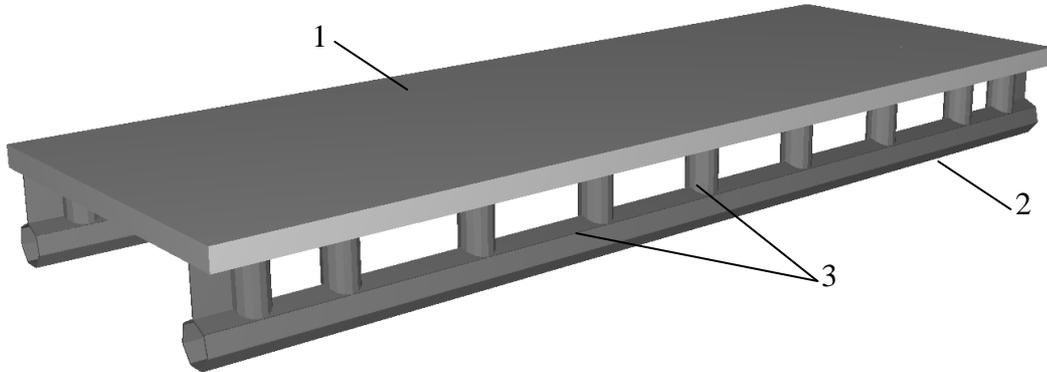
Сталезалізобетонна плита з винесеним армуванням трубами
